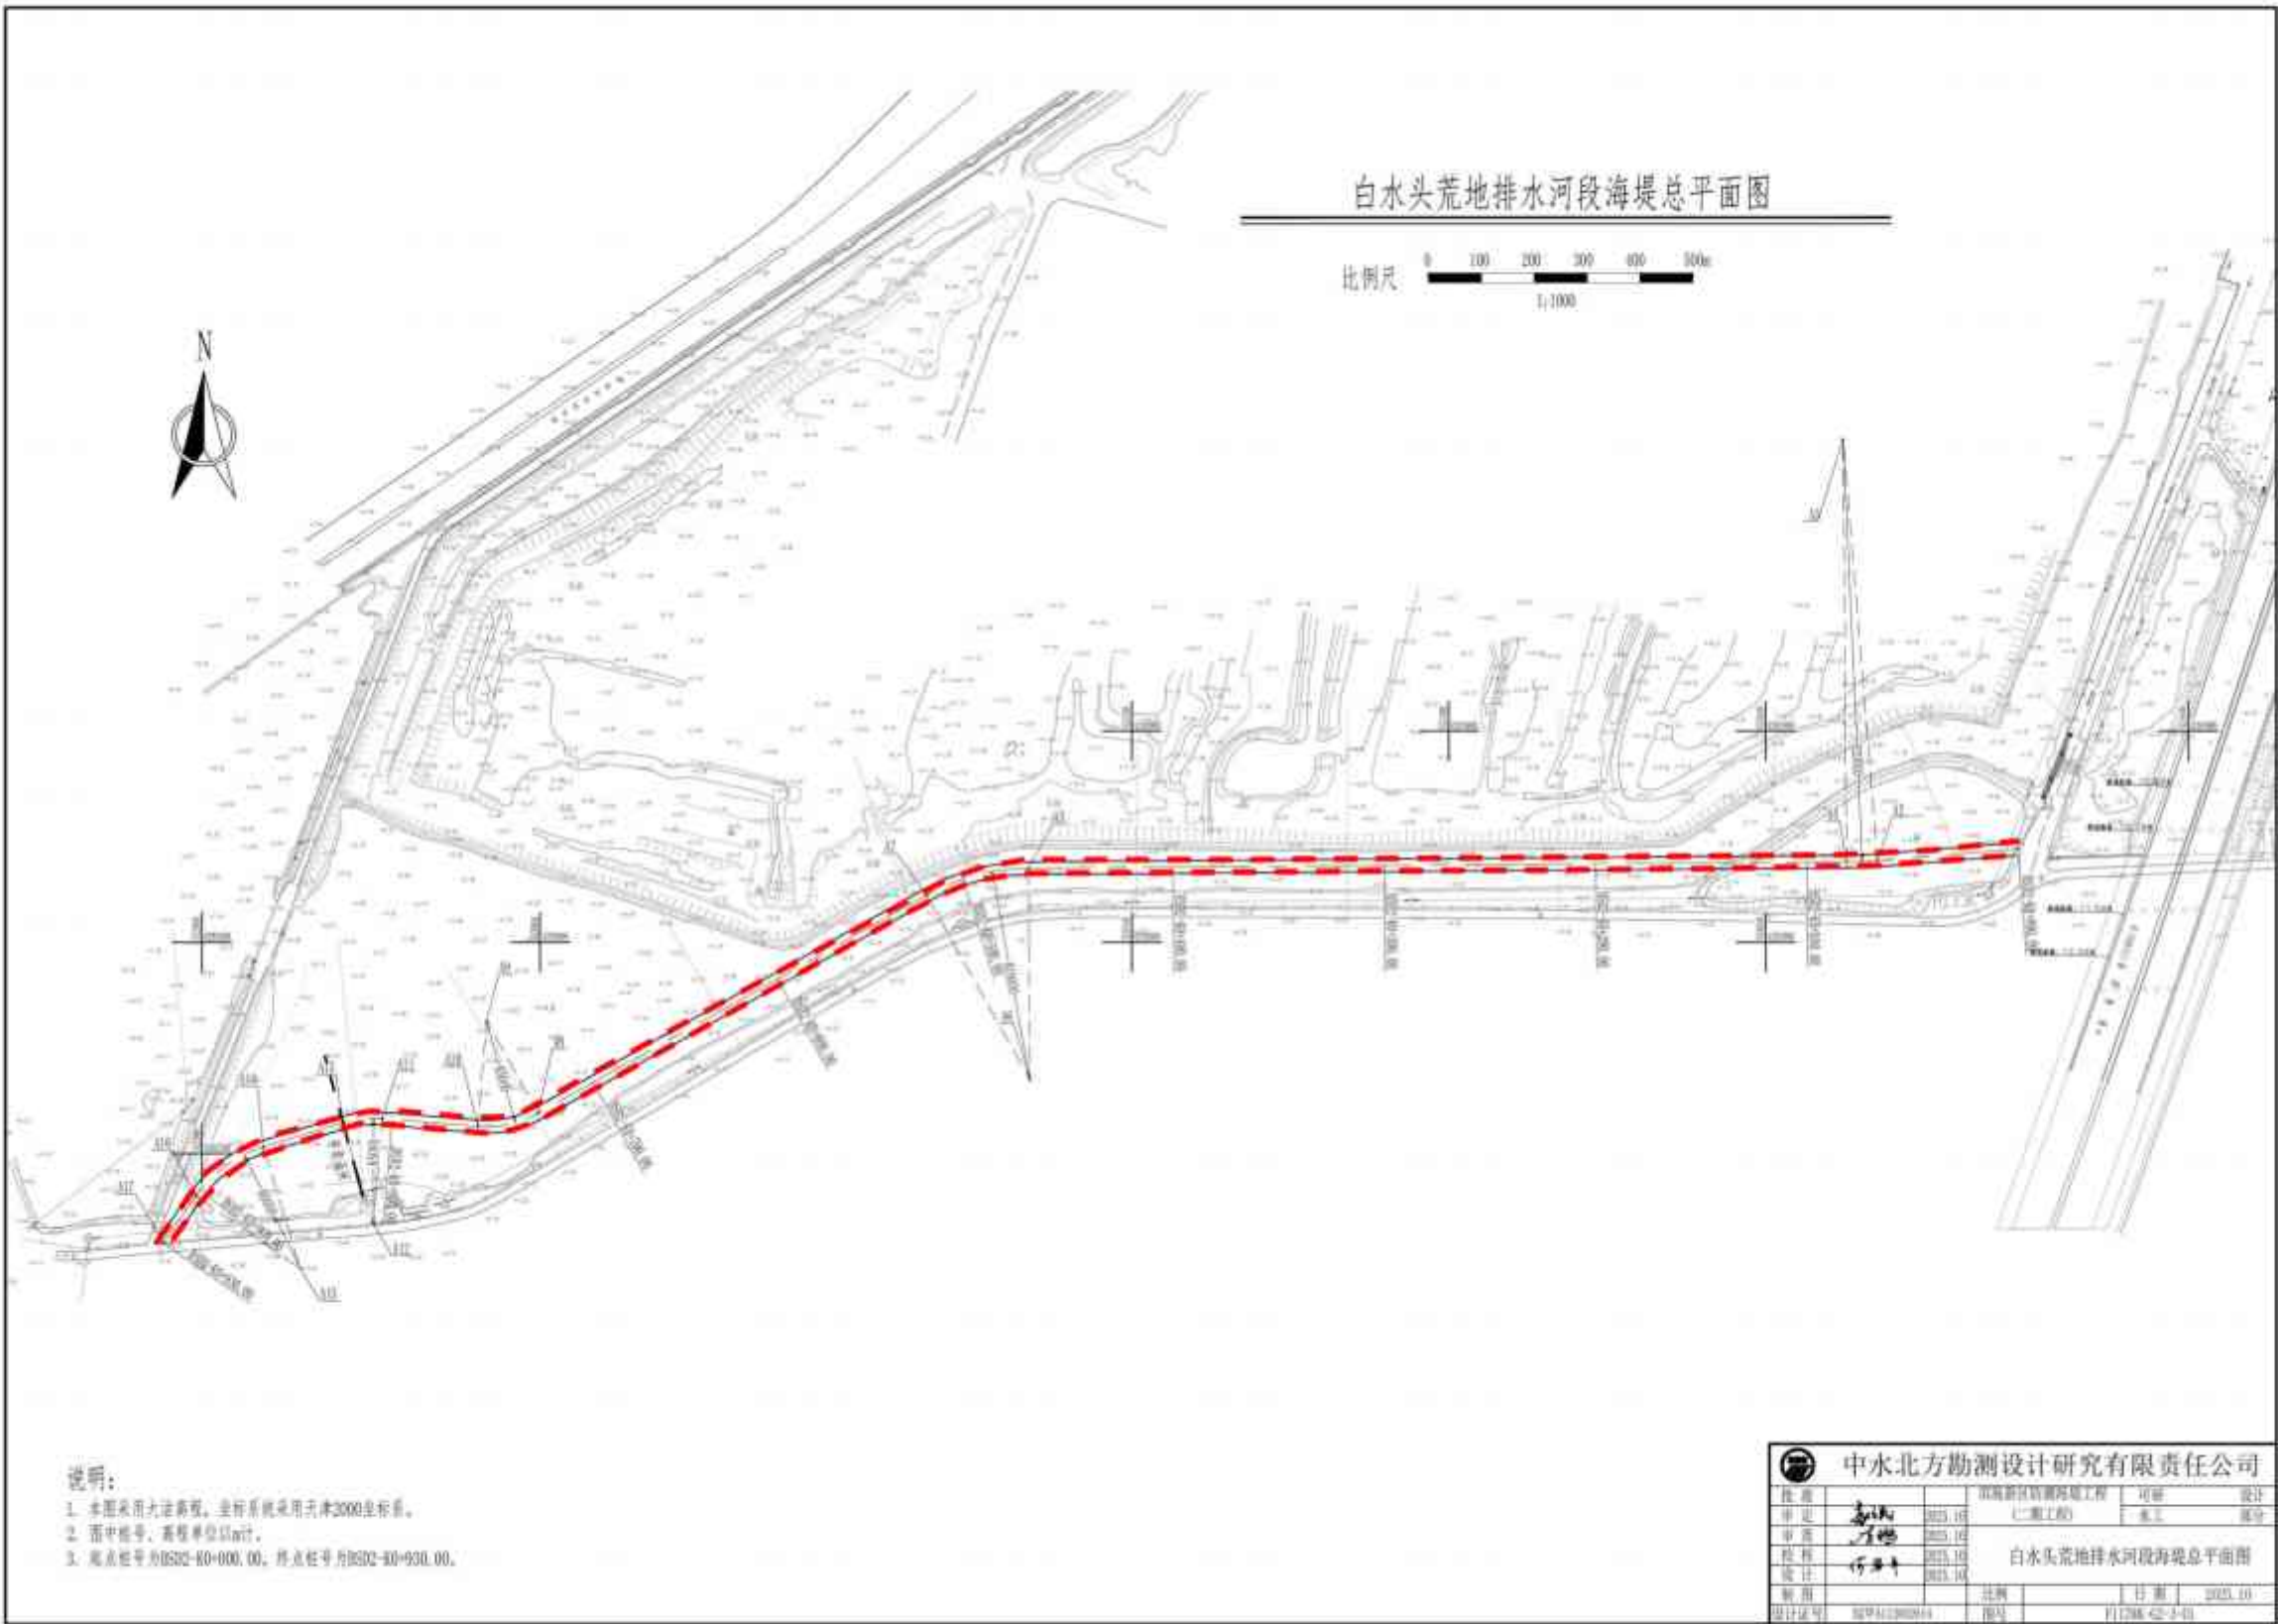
白水头荒地排水河段海堤总平面布置图
